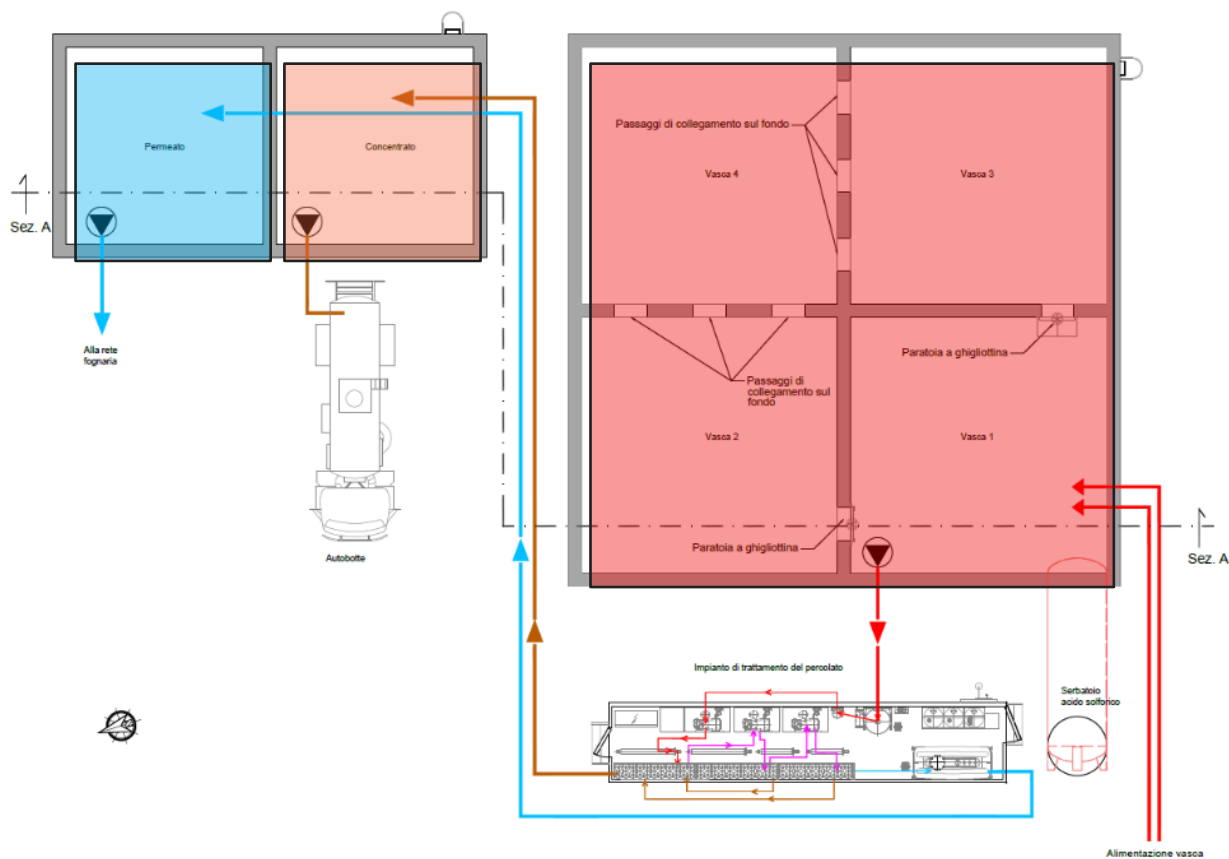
Pianta e schema di flusso dell'impianto di trattamento del percolato
